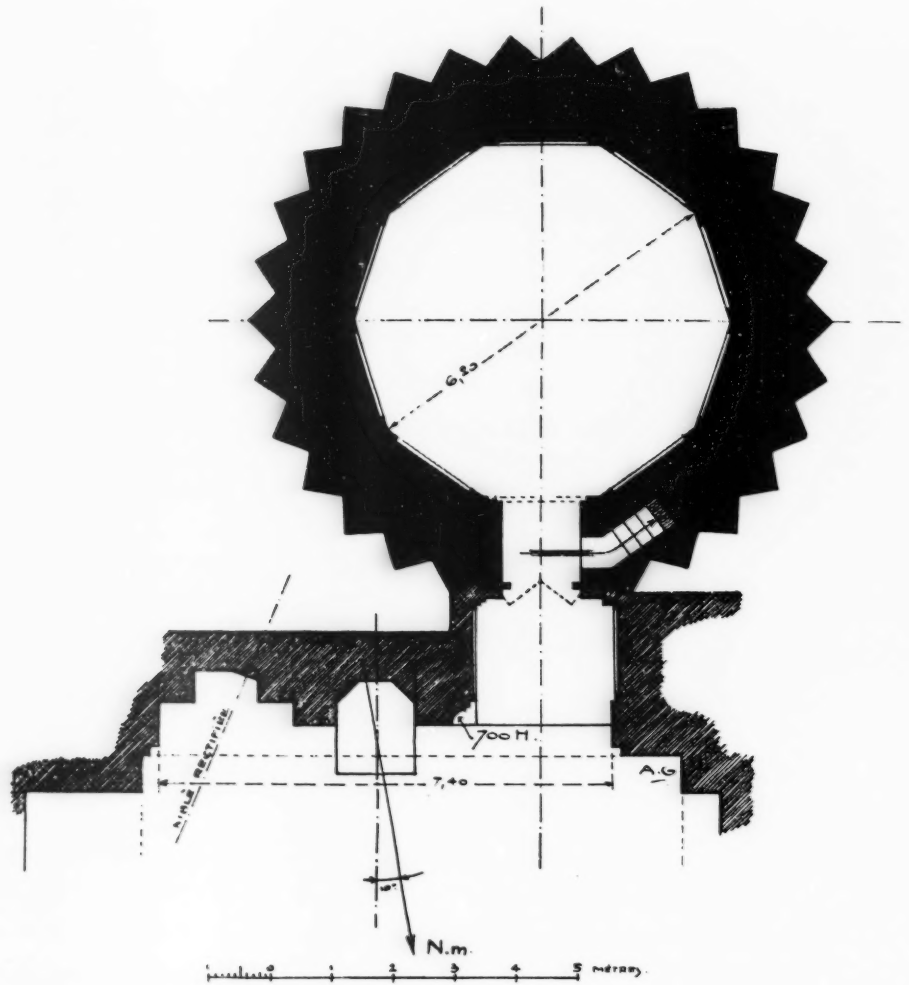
BASTĀM. PLAN DE LA TOUR ADJACENTE
